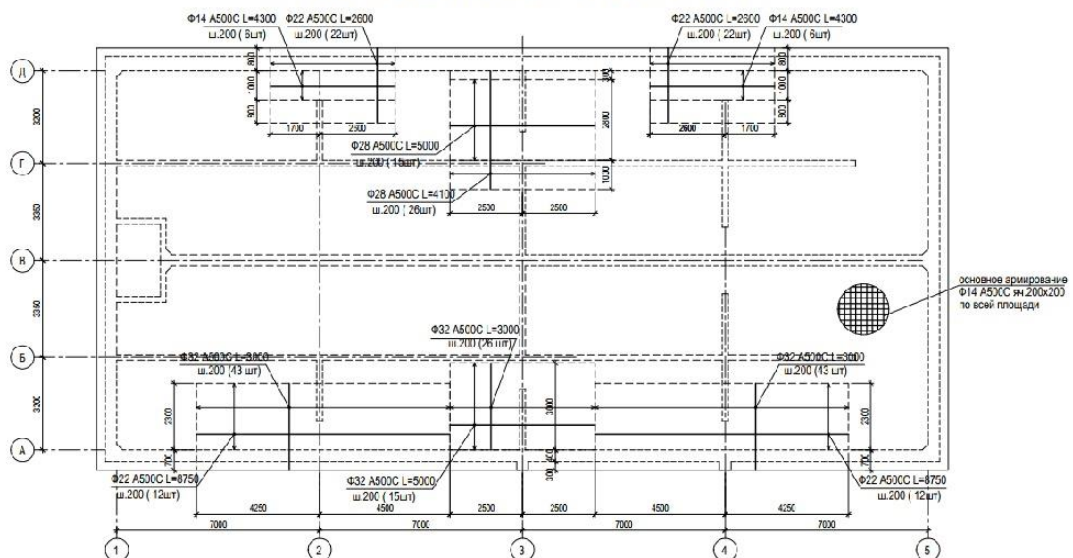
Проектом верхнее дополнительное армирование по оси В вдоль числовых осей не предусмотрено
